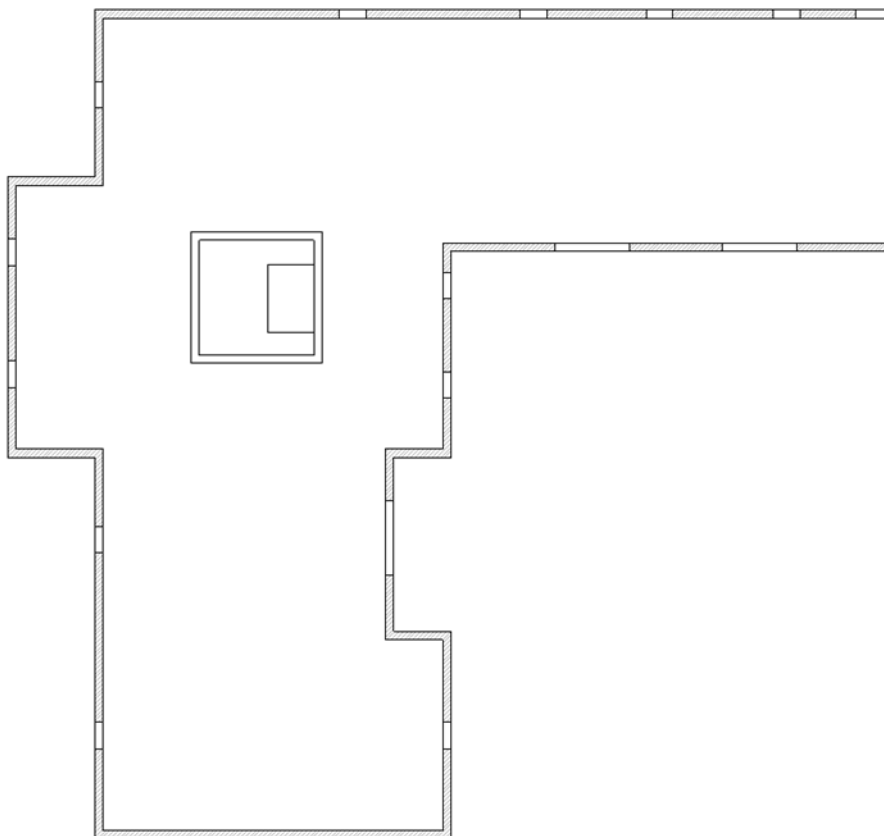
Etape numéro 1 du plan du plancher haut du niveau 1
